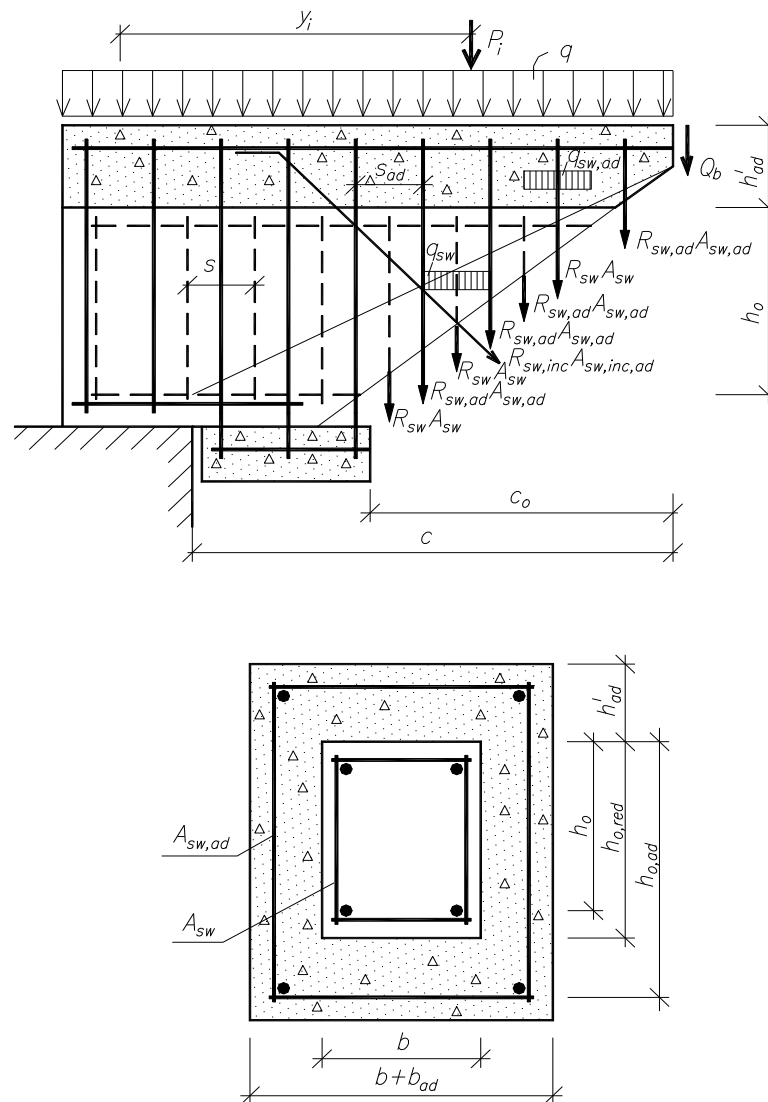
Схема усилий в наклонном сечении усиленной конструкции при расчете на действие поперечной силы
